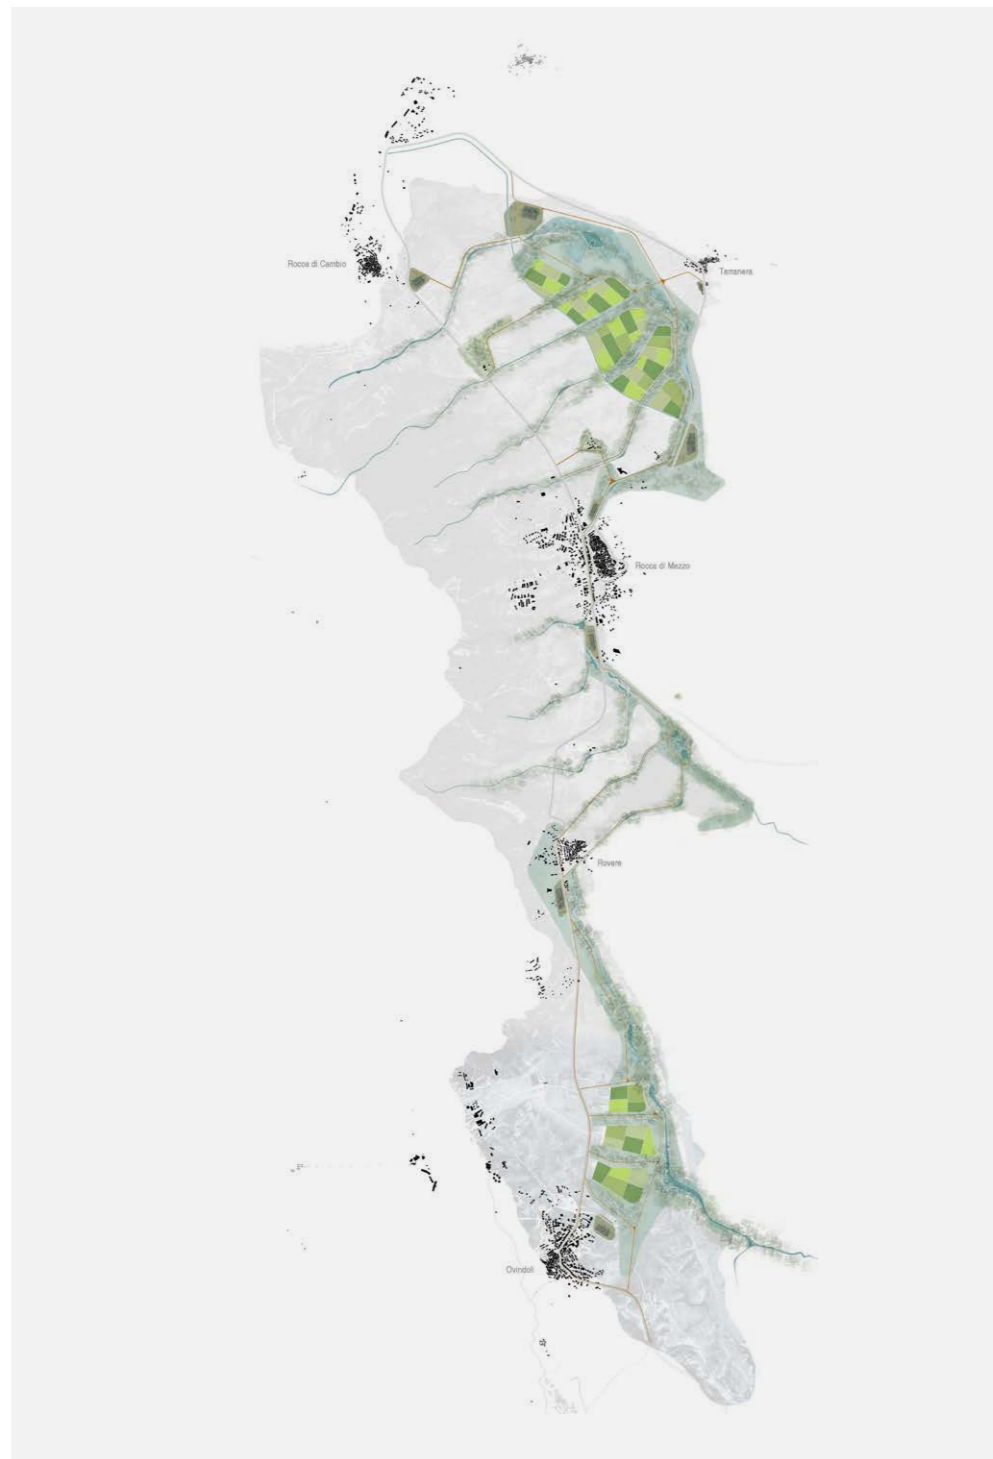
Planimetría general del proyecto del parque del Altiplano de las Rocas. Autores: Fabrizio Toppetti con la colaboración de Eliana Strano. Fuente: Toppetti (2014).
